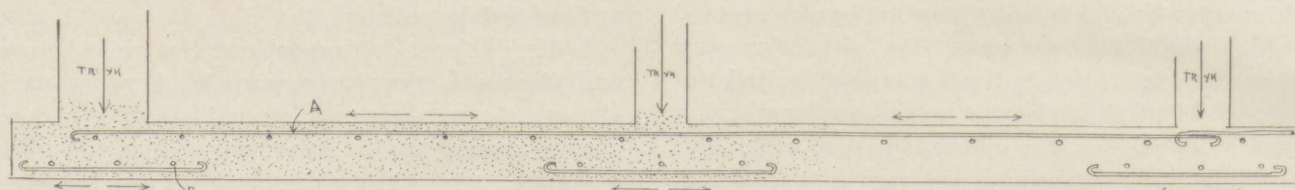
Betonfundament armeret ved rundtjern (pilene angir strækpaakjending i fundamentet).
